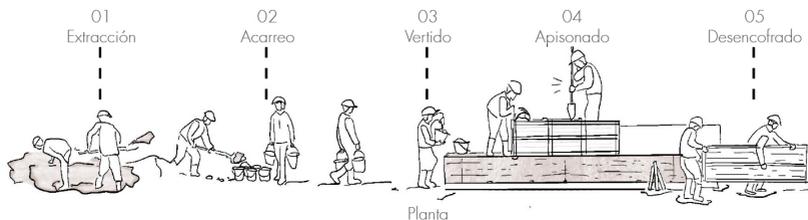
| Construcción de tabiques con tapial. | Fuente: Autoría Propia (2024).
